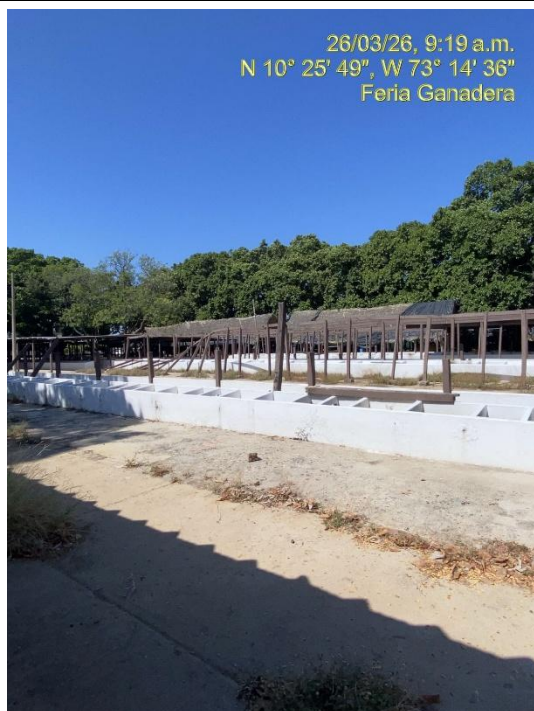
Ausencia de cubierta en establos. Zona 3.
